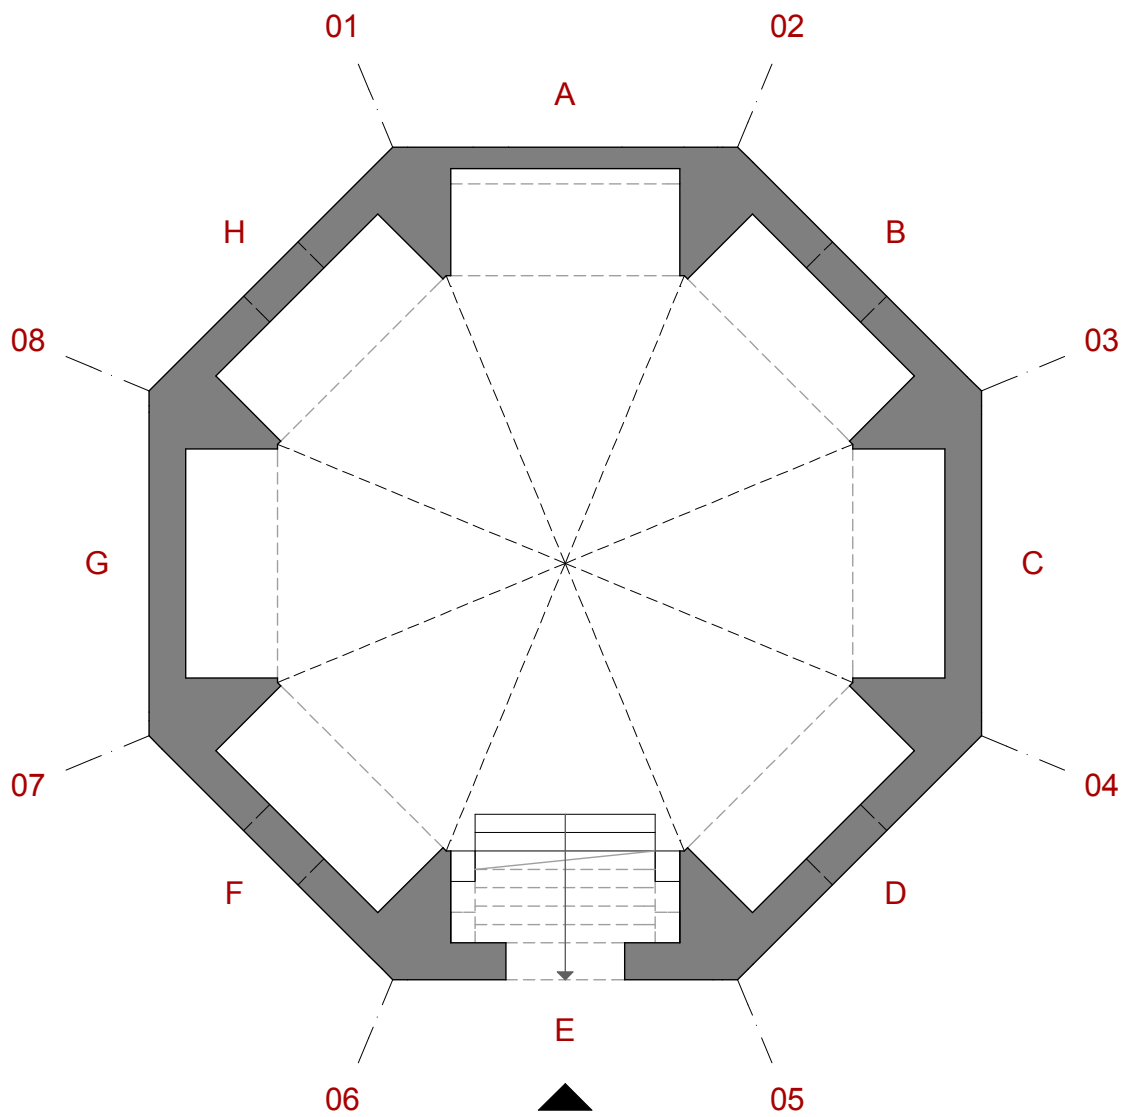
Übersichtsgrundriss (Skizze) des Kellergeschosses, M 1:100.
